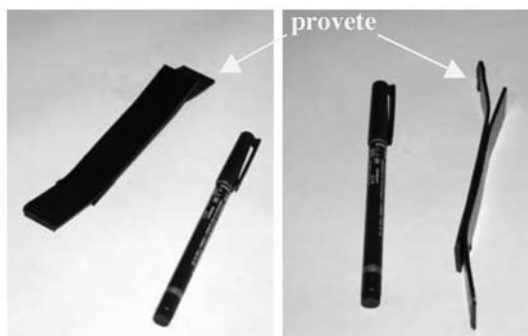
Amostra da geomembrana, com uma dupla soldadura por termofusão, a meio.
